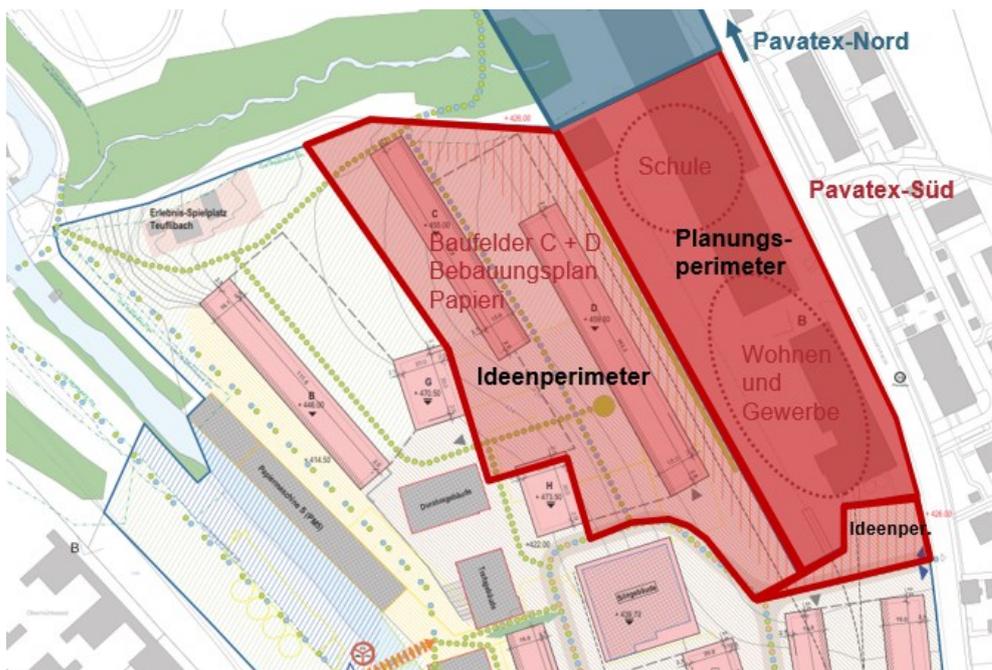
Planungsperimeter und Ideenperimeter mit Bebauungsplan Papieri hinterlegt, EBP 2022
